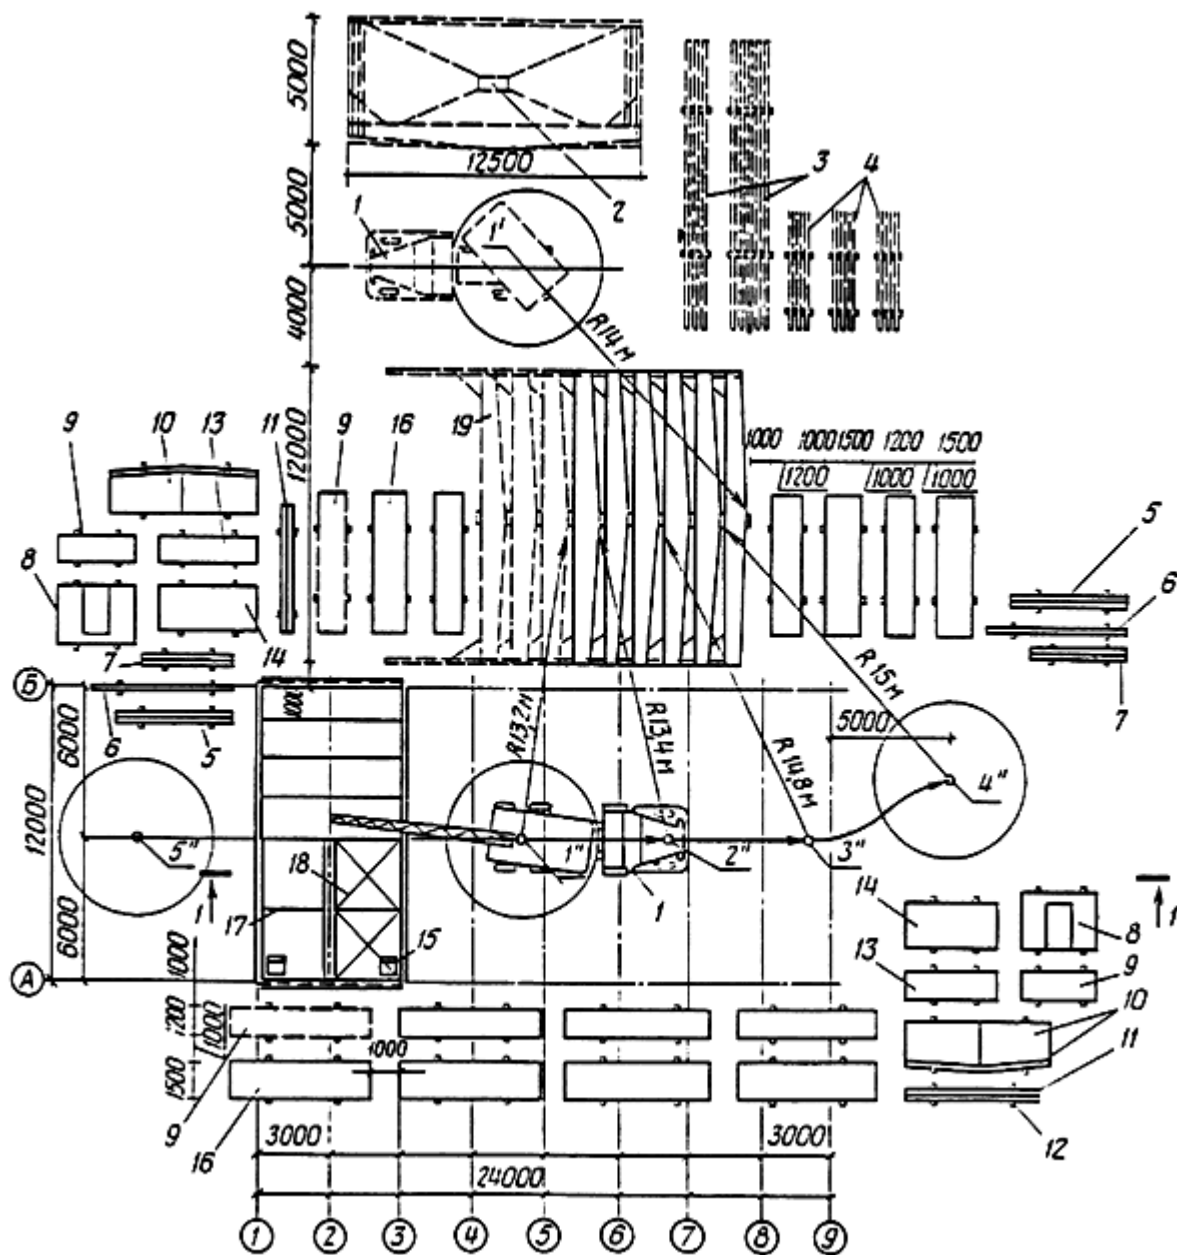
Схема организации строительной площадки при укрупнении рам и монтаже каркаса (вариант II):
